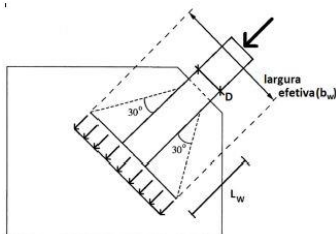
Largura efetiva da chapa de gousset para uma ligação soldada, adaptado de [41].
